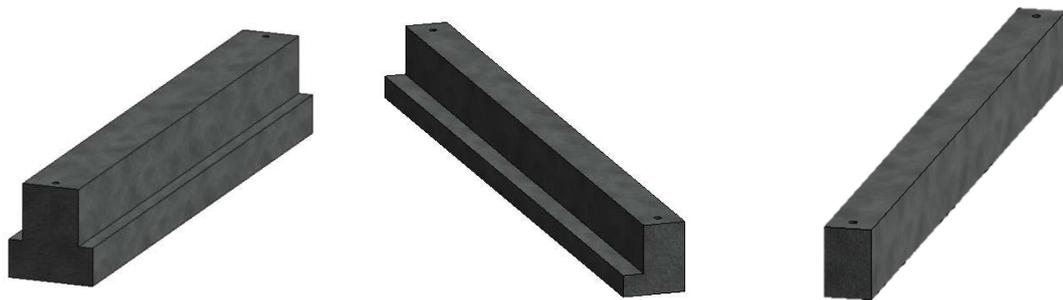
Elemento Trave prefabbricata; sezione a T rovescia, "elle" e rettangolare (modello Revit).
